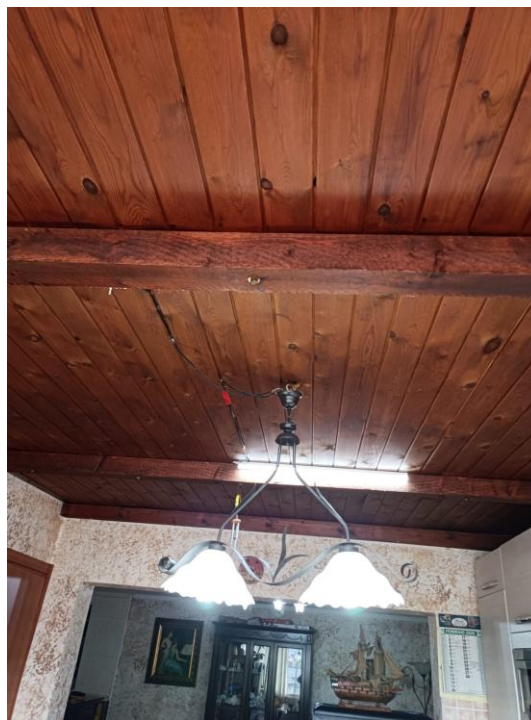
copertua lignea della porzione chiusa a veranda al terzo piano
